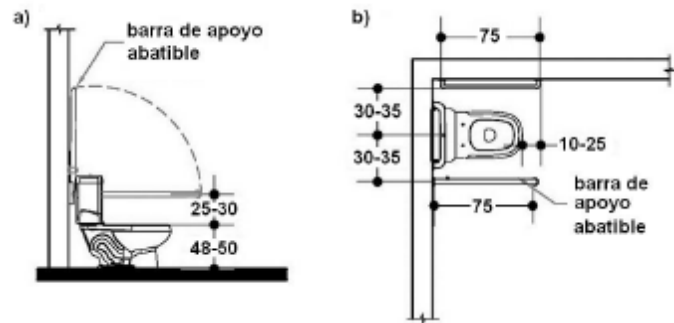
Vista lateral y en planta de un servicio sanitario adaptado.
